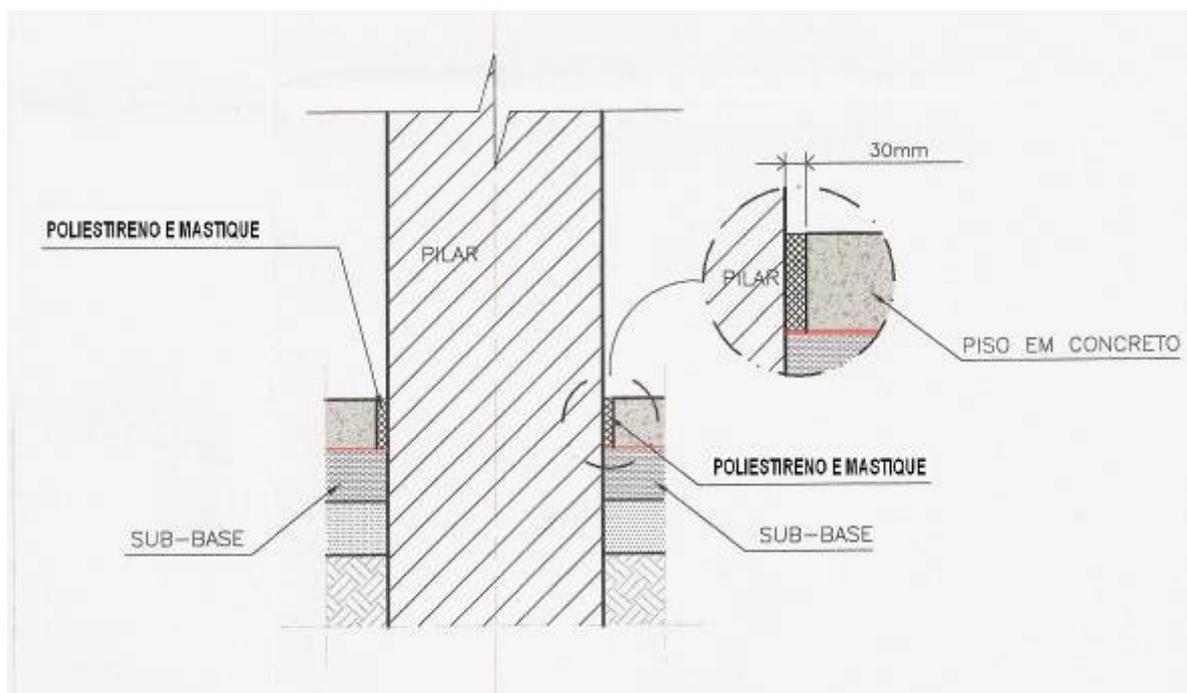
Detalhe de Junta de Encontro com Elemento Estrutural Inserido na Placa (Vista em Corte)
